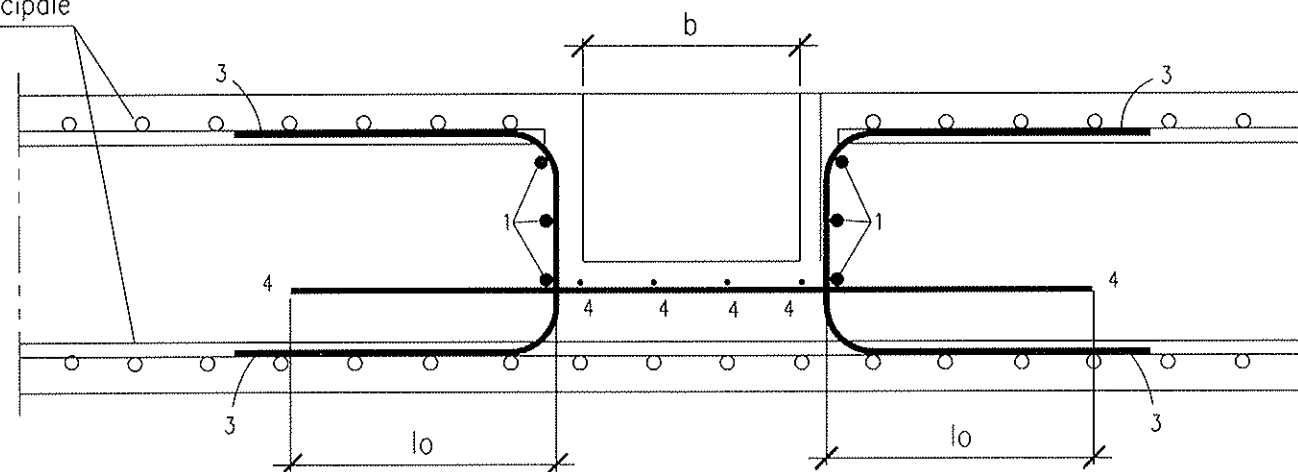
# DETAIL DE RENFORTS DES DECAISSES DANS DALLES VUE EN PLAN Décaissés simples
